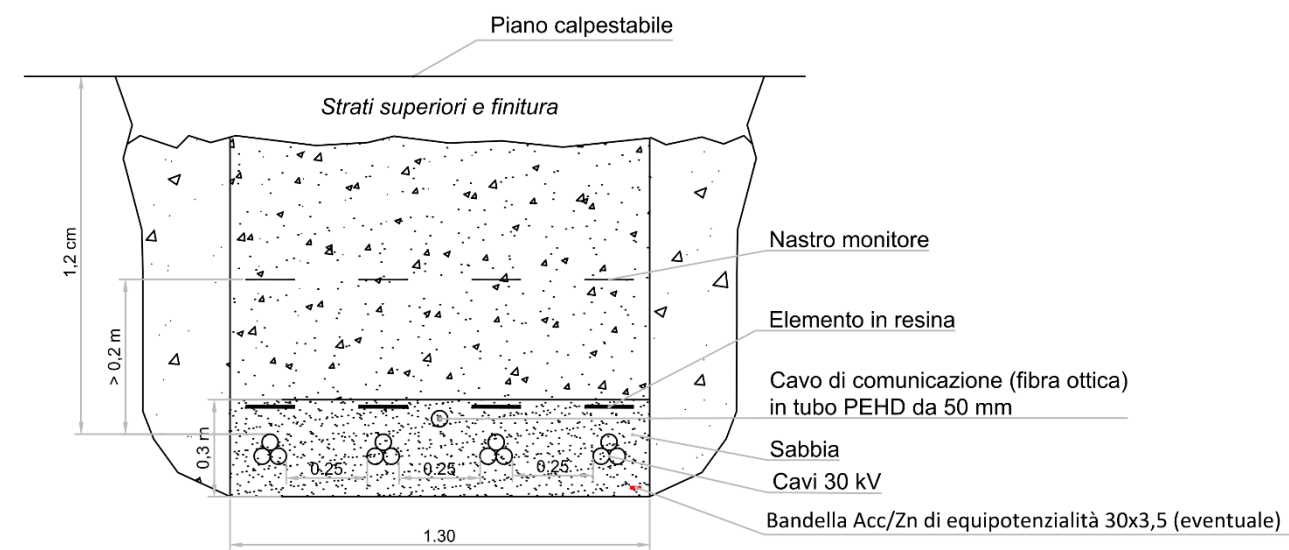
sezione tipo posa cavidotti 30 kV su campo/banchina
